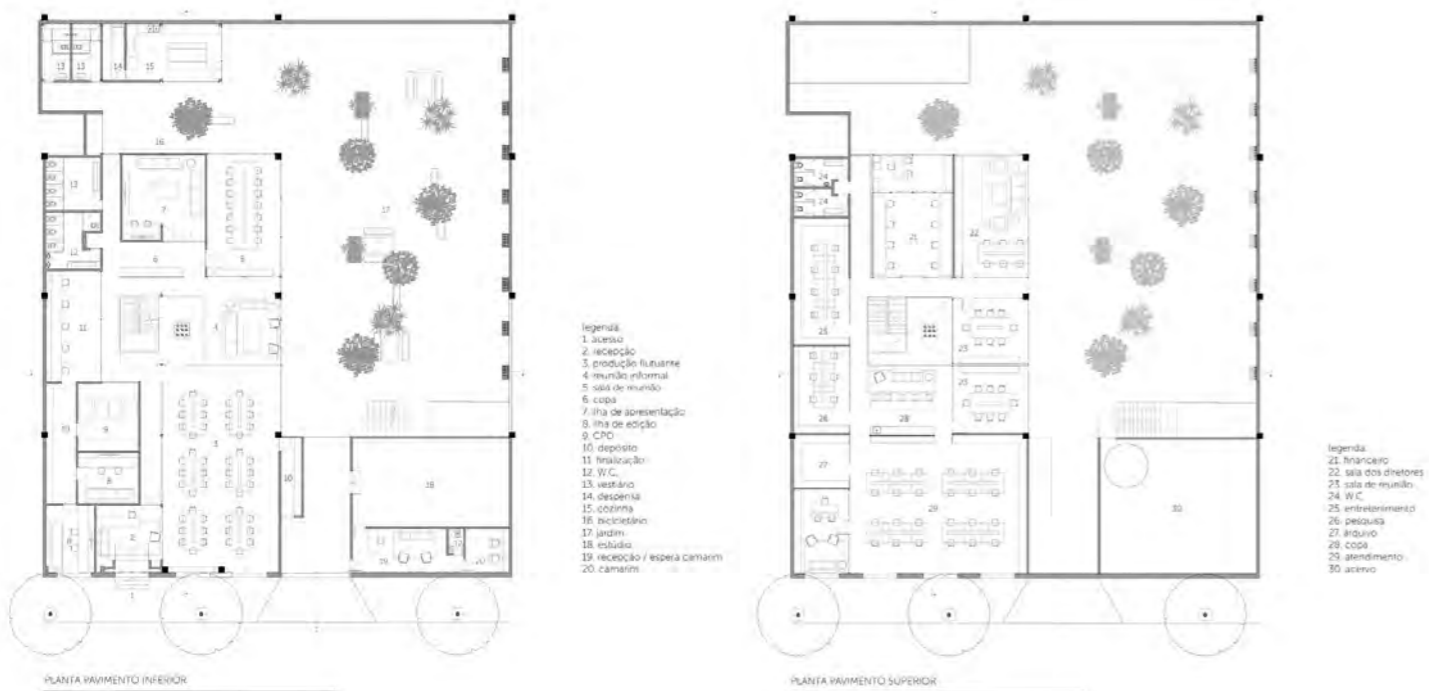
Plantas dos pavimentos inferior e superior, respectivamente.
